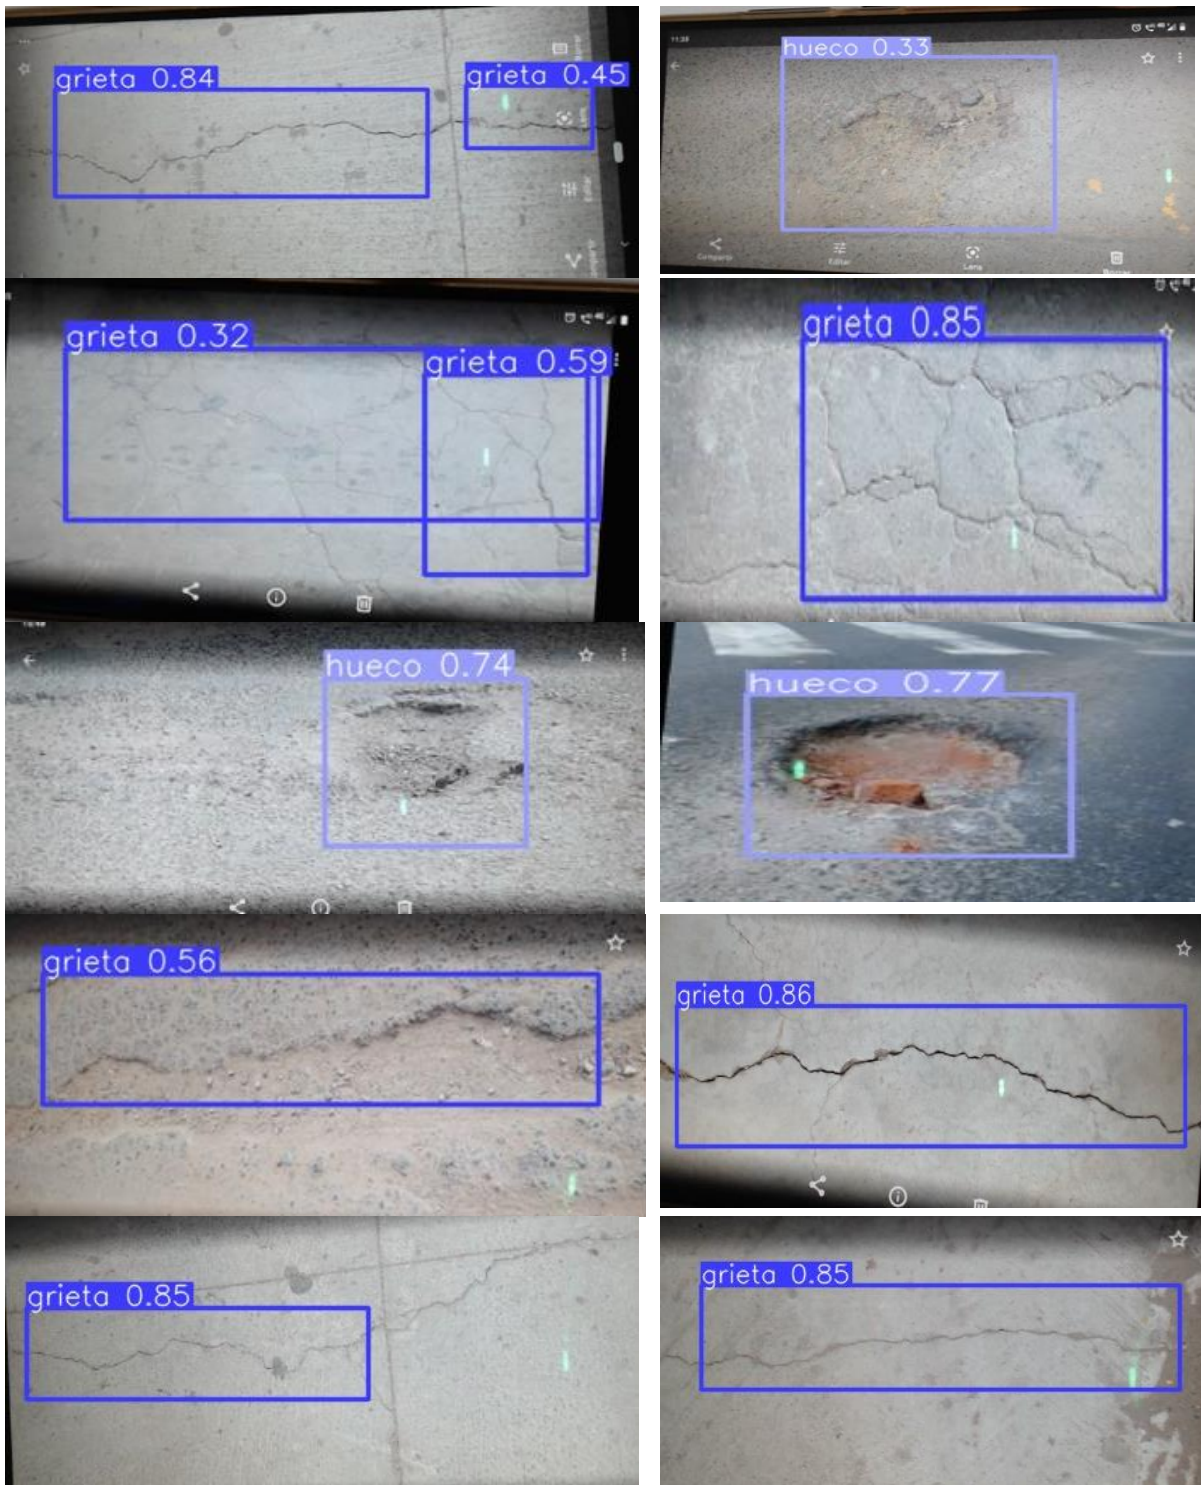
Matriz de imágenes capturas, donde se evidencia las dimensiones de grietas y huecos sobre los pavimentos de asfaltado y concreto.
